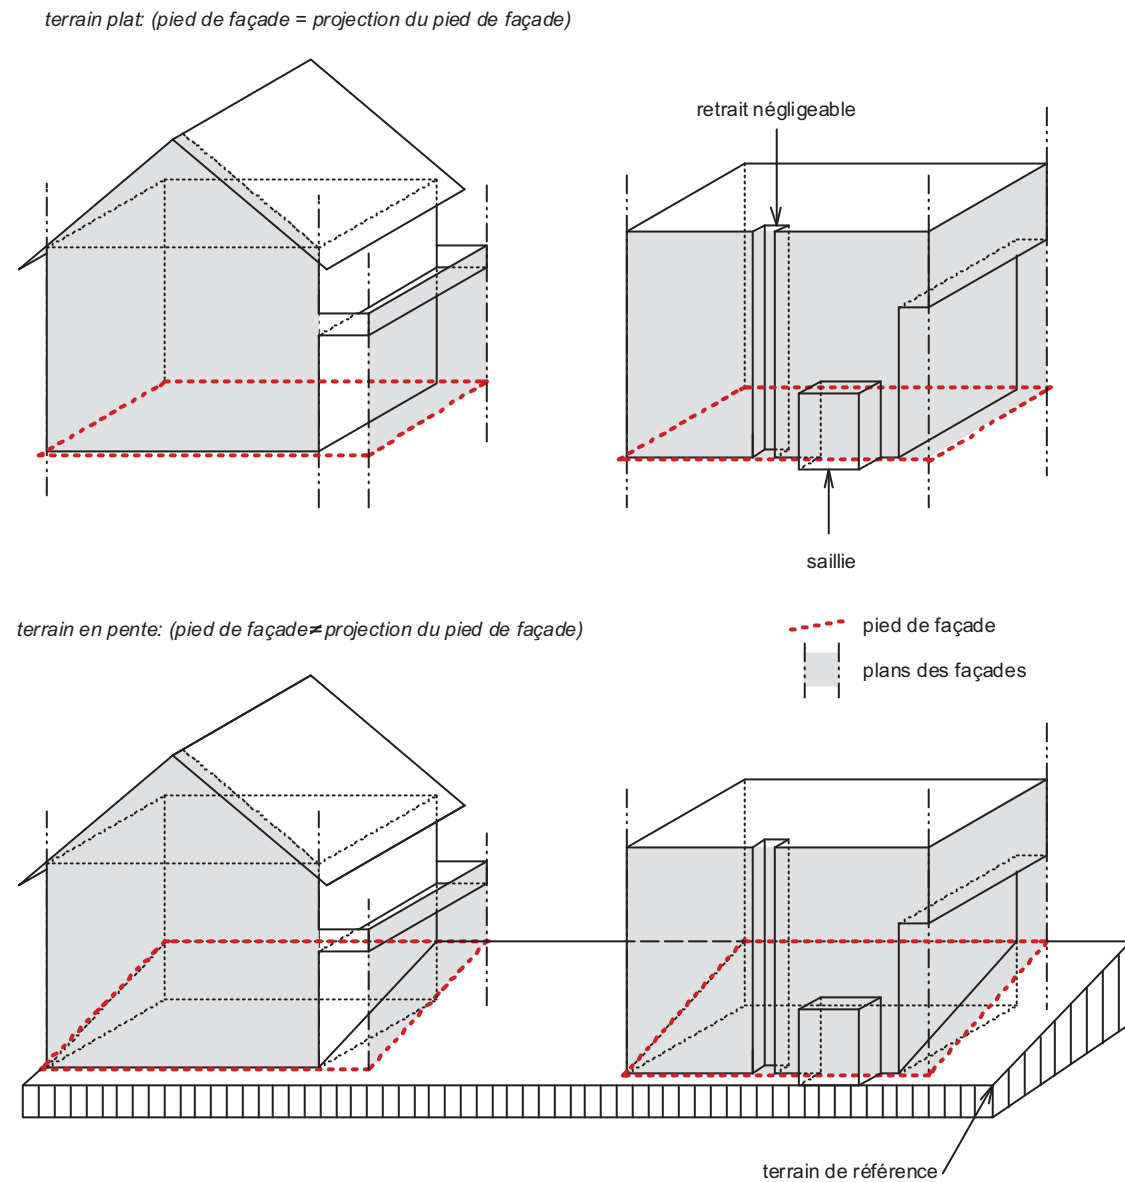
3.3 Plans des façades et projection du pied de façade
